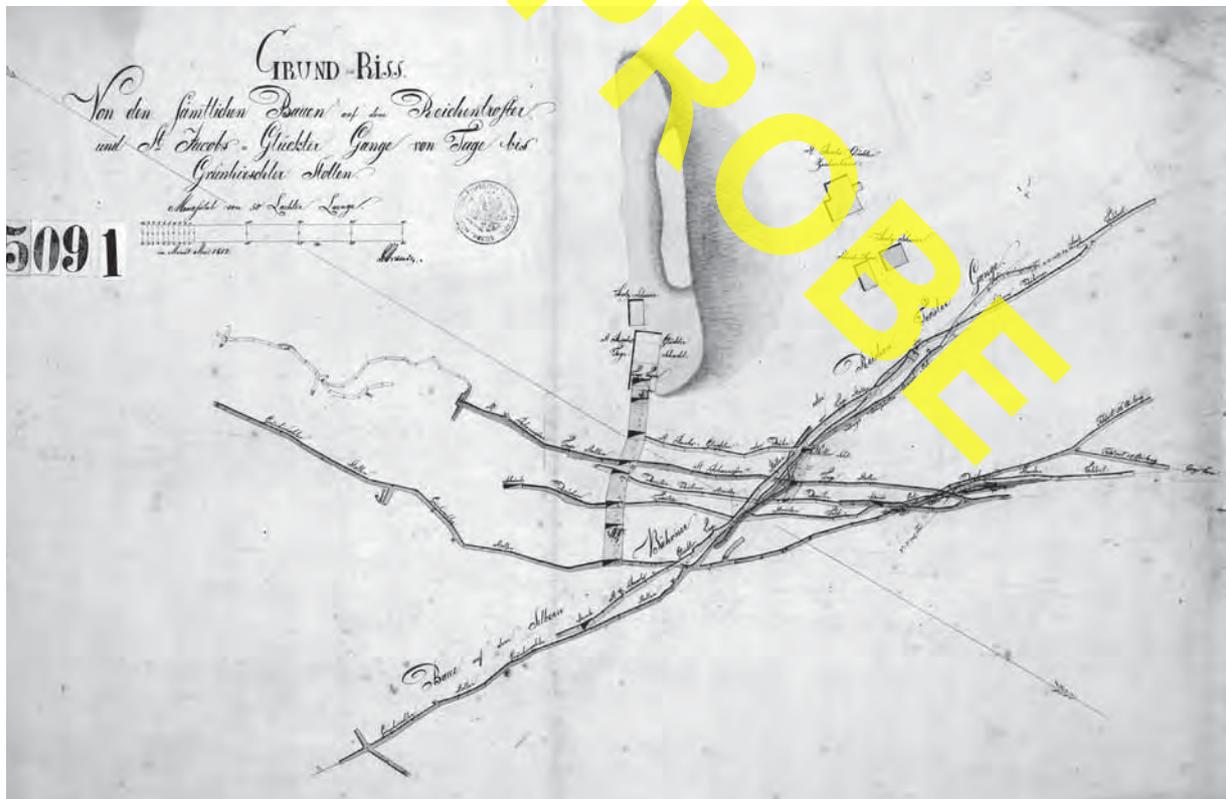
Grundriss des St. Jacobsglückler Tagesschachtes und seiner Strecken oberhalb der Grünhirscher Stollensohle (STRAUCH 1812); gut erkennbar ist die Durchschneidung mit dem Reichen Troster Gang.²⁰⁶
